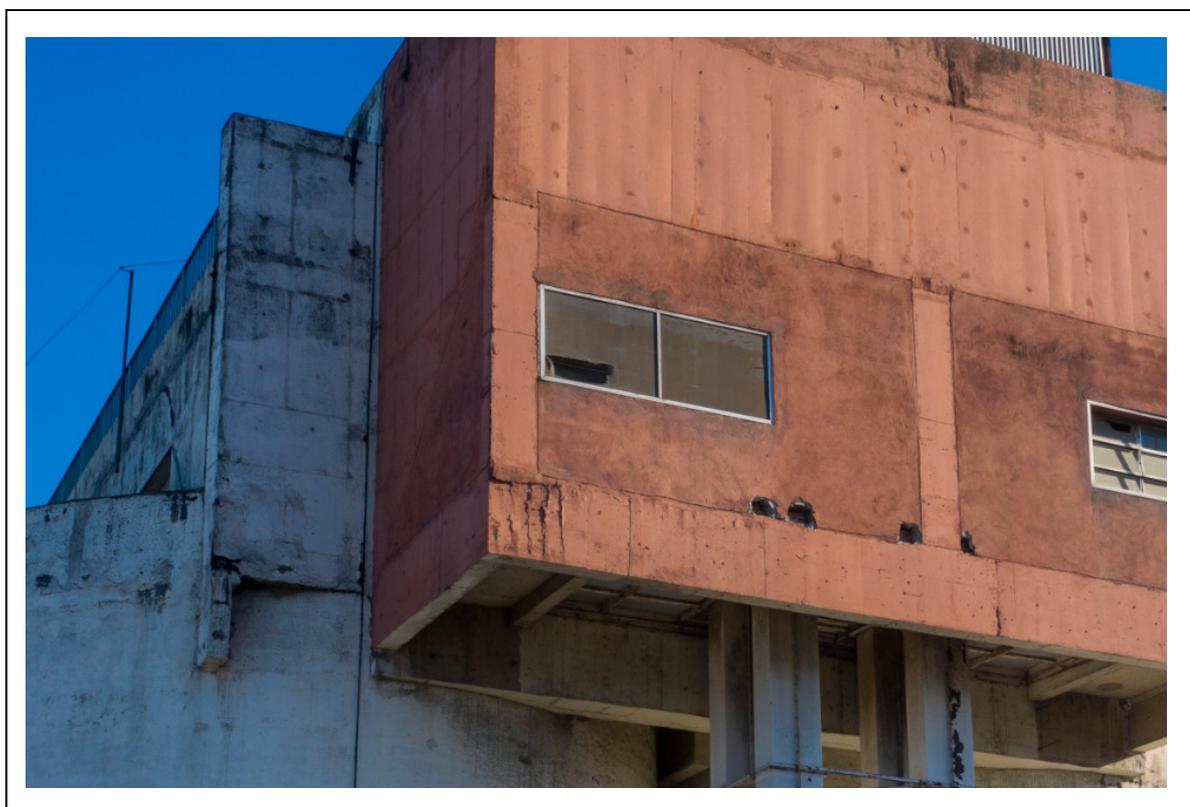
DETALHE DA FOTO ANTERIOR.
